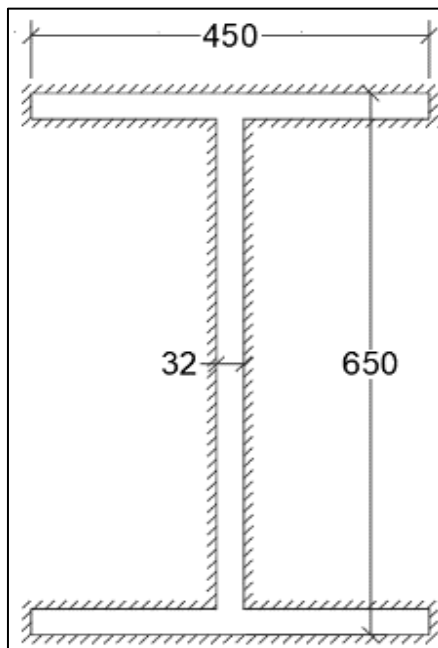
Perfil de la Columna "C2" - Sistema estructural mixto.
